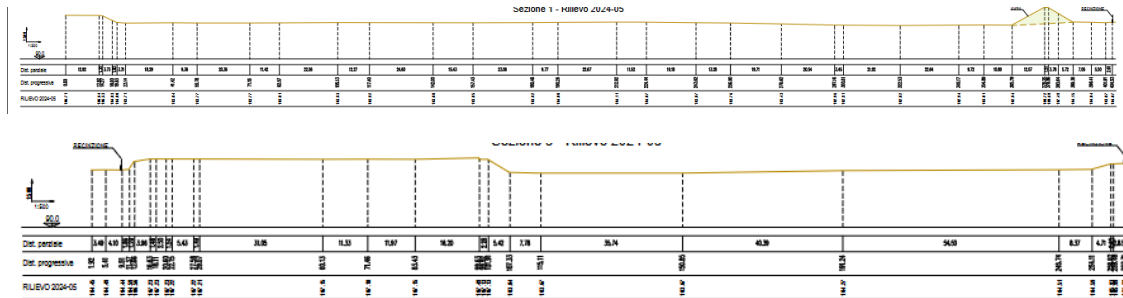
Sezioni longitudinali e trasversali dell’area oggetto di studio
